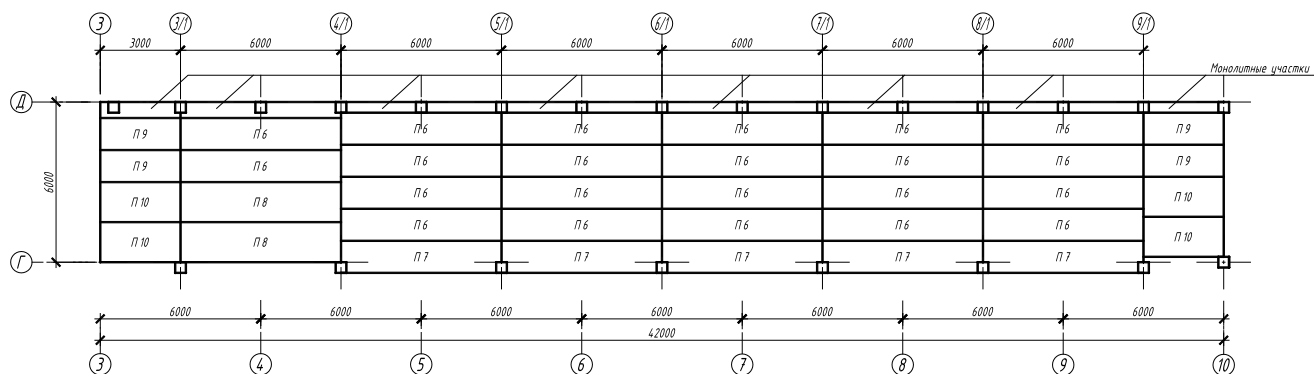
Схема розташування плит перекриття на відм. +4,800
